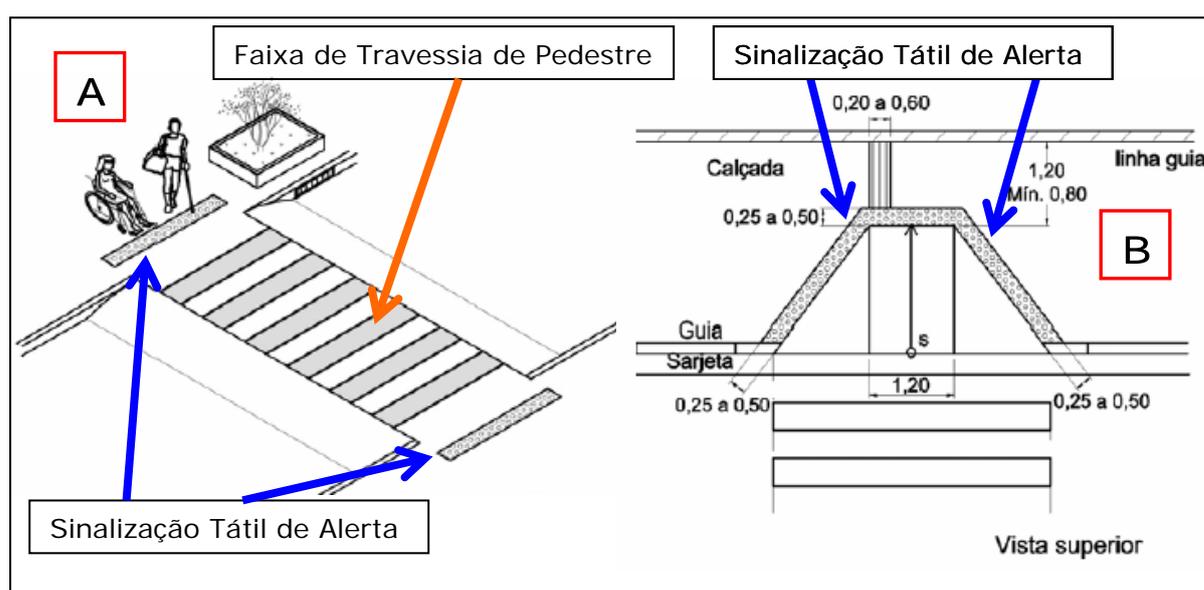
Sinalização tátil de alerta e faixa de travessia de pedestres em piso elevado (A) e sinalização tátil de alerta em rebaixamento de calçada (B).
